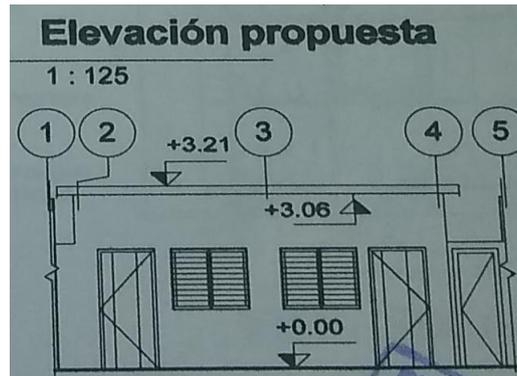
Elevación Propuesta de la vivienda de Tipología I. Fuente: Foto tomada por la autora al informe del proyecto facilitado en Planificación Física.
